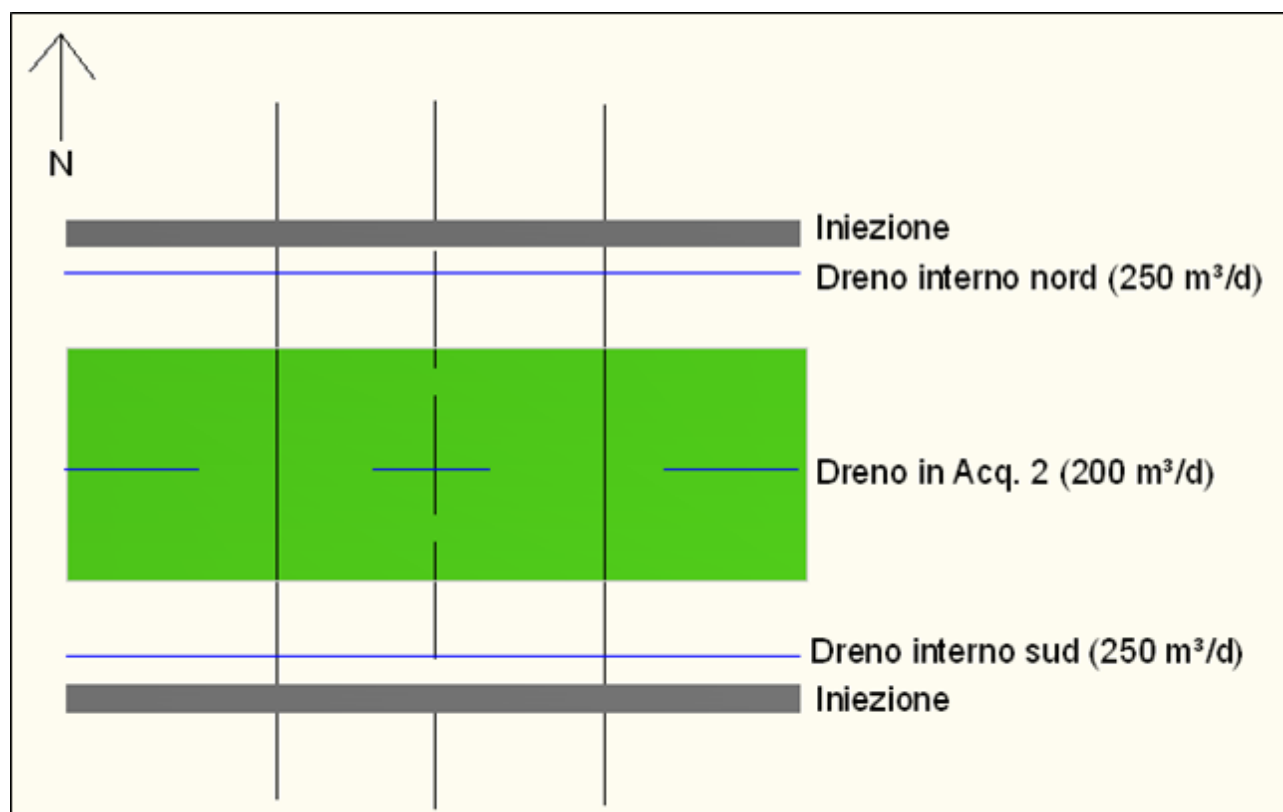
Vista in pianta del sistema di iniezioni e degli interventi di drenaggio.
